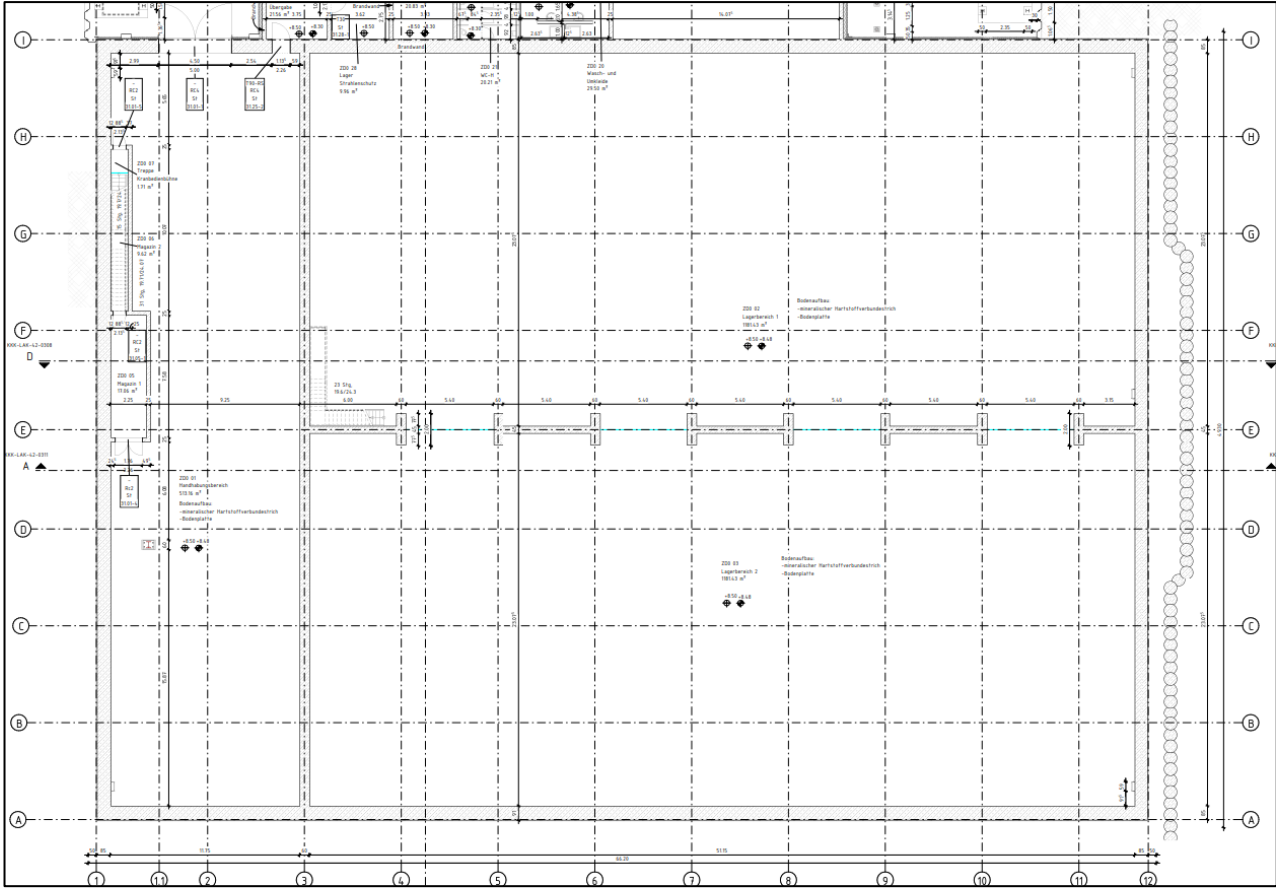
Betrachtetes Gebäude - Grundriss Lagergebäude (+8,50 m NN)
